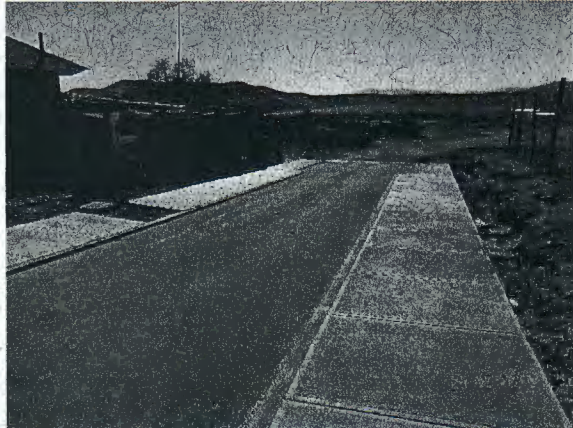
Fisuras en murete y muro de mampostería, a lo largo de toda la calle Hernán Aravena y calle 2.
